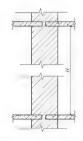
有钢筋混凝土 楼板隔层内墙高度
